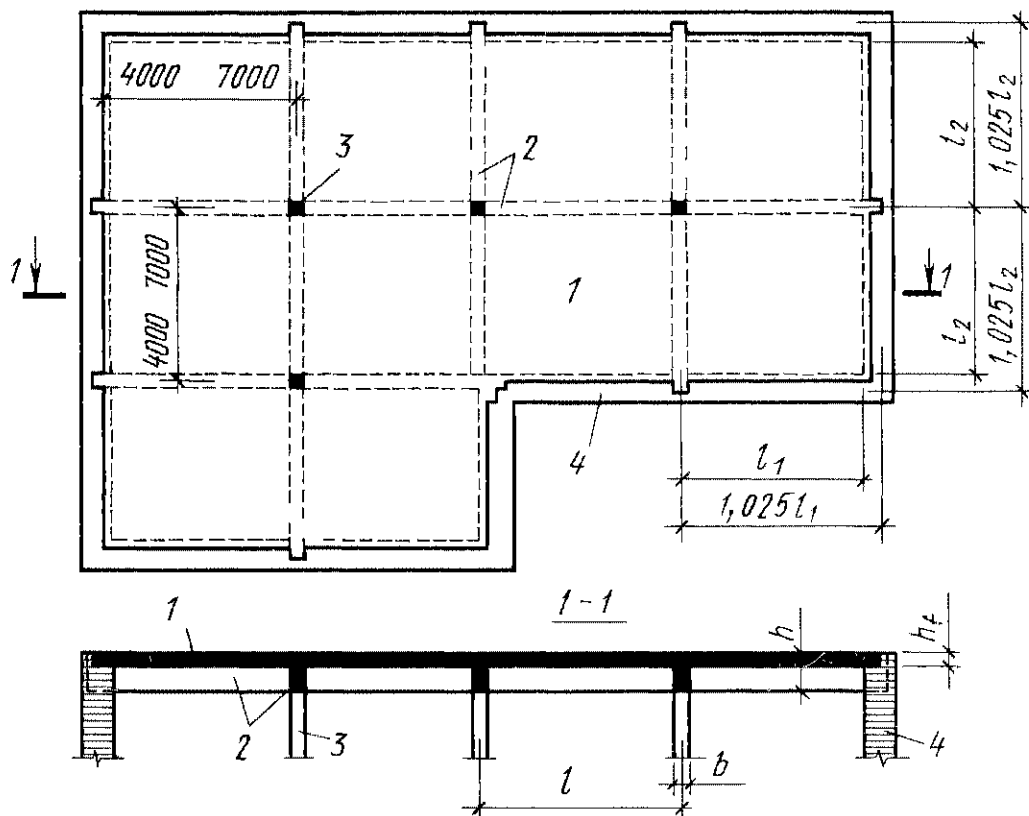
Ребристое перекрытие с плитами, работающими в двух направлениях (кессонное перекрытие)
